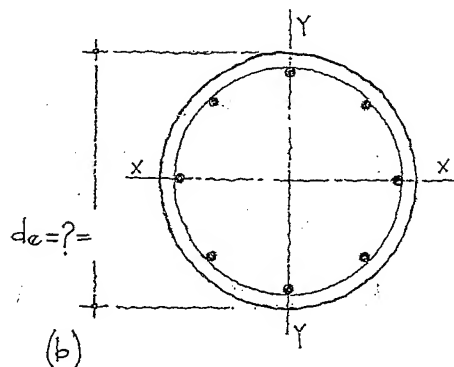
b. Columna zunchada vista en planta, (b).
